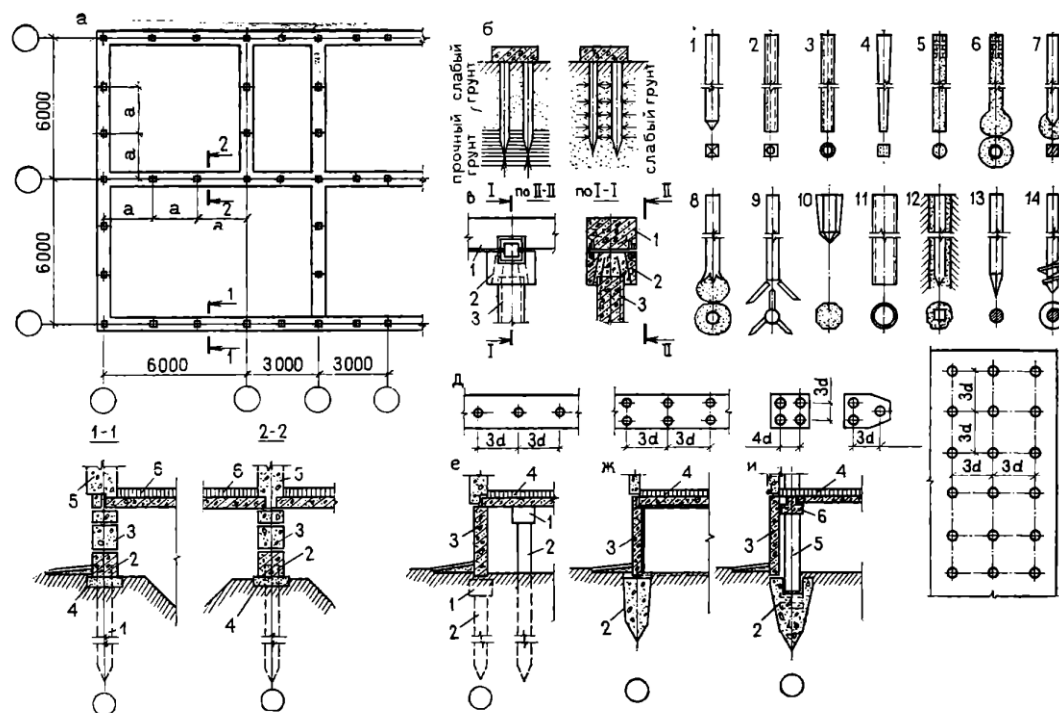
Свайные фундаменты: а – план и разрезы; б – виды свай в зависимости от грунта – сваи-стойки, опирающиеся на прочный грунт, и висячие сваи. Работающие на трении; в – элементы свайного фундамента: 1-ростверк; 2 – оголовок; 3-свая; г - виды свай – 1-четыре забивные бетонные и железобетонные сваи-квадратные, круглые, сплошные и пустотелые; 5,6 – набивные обычные и с уширенной пятой; 7-8-камуфлетные; 9 – с шарнирно раскрывающимися упорами; 10-призматические сваи; 11 – свая-оболочка; 12 – свая в лидерной скважине; д – расстановка свай; е – вариант свайного безростверкового фундамента; ж, и – свайные фундаменты без ростверка и оголовка
